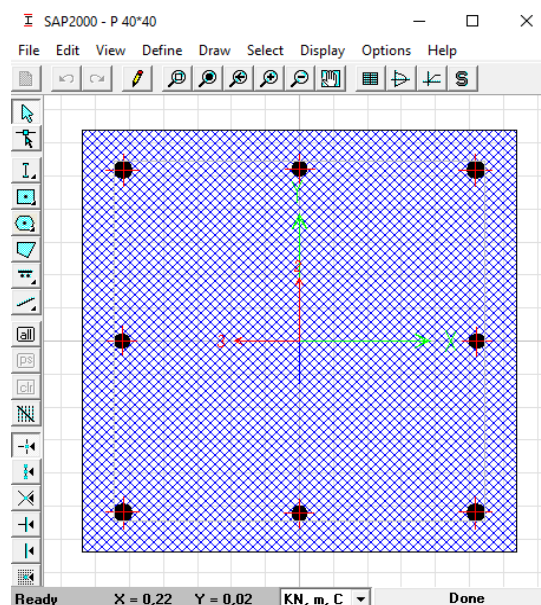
Dessin de ferrailage des poteaux (40×40)
